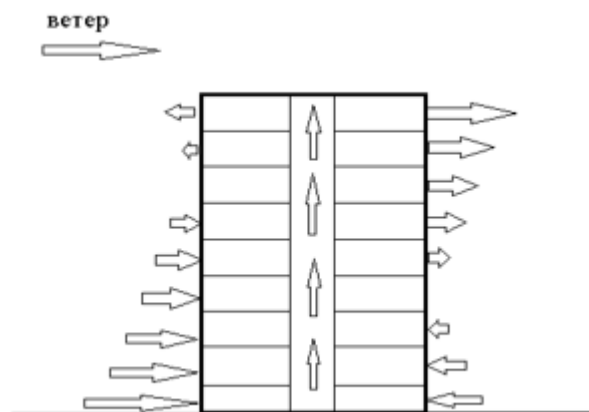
Схема вертикального перемещения потоков воздуха в здании
